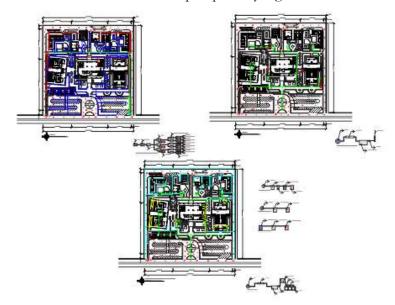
denah bangunan (Sumber : Data Pribadi 2020)
